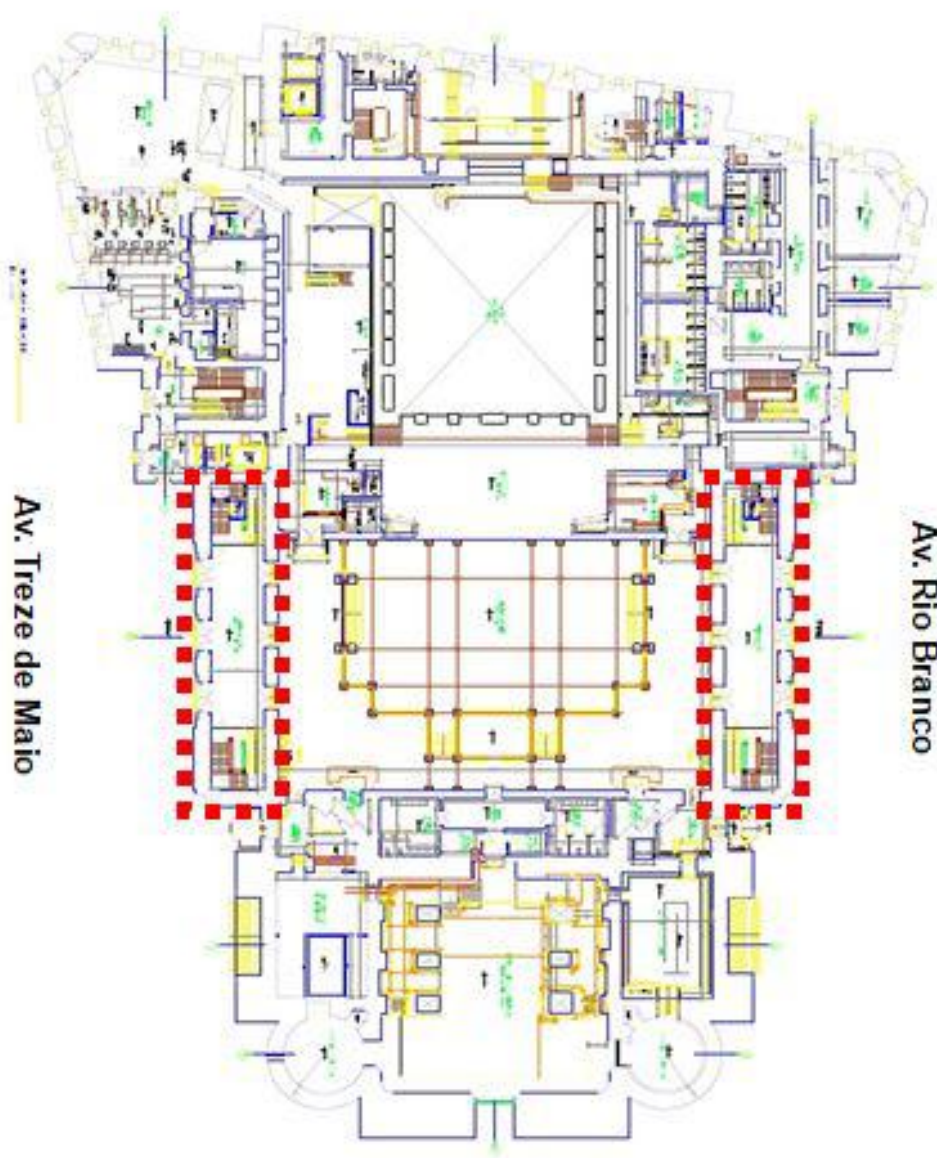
Planta do primeiro pavimento do Teatro Municipal destacando a localização das varandas.
